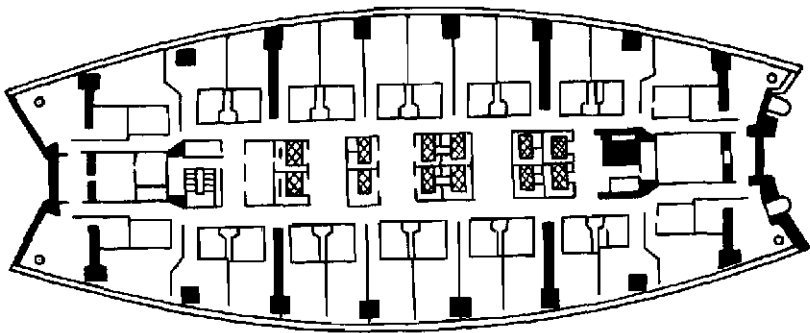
中国南海石油中心“珠江帆影”方案平面示意图
